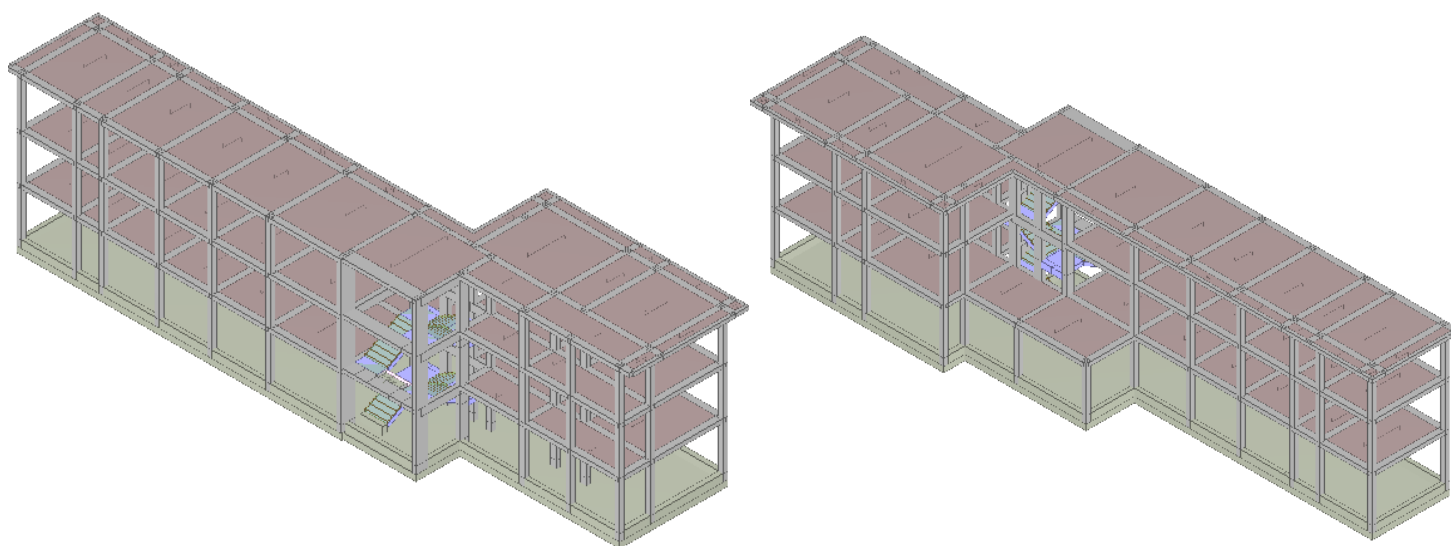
Schema rappresentativo intervento di ampliamento, Figura 3 – vista prospettica anteriore, Figura 4 – vista prospettica posteriore
